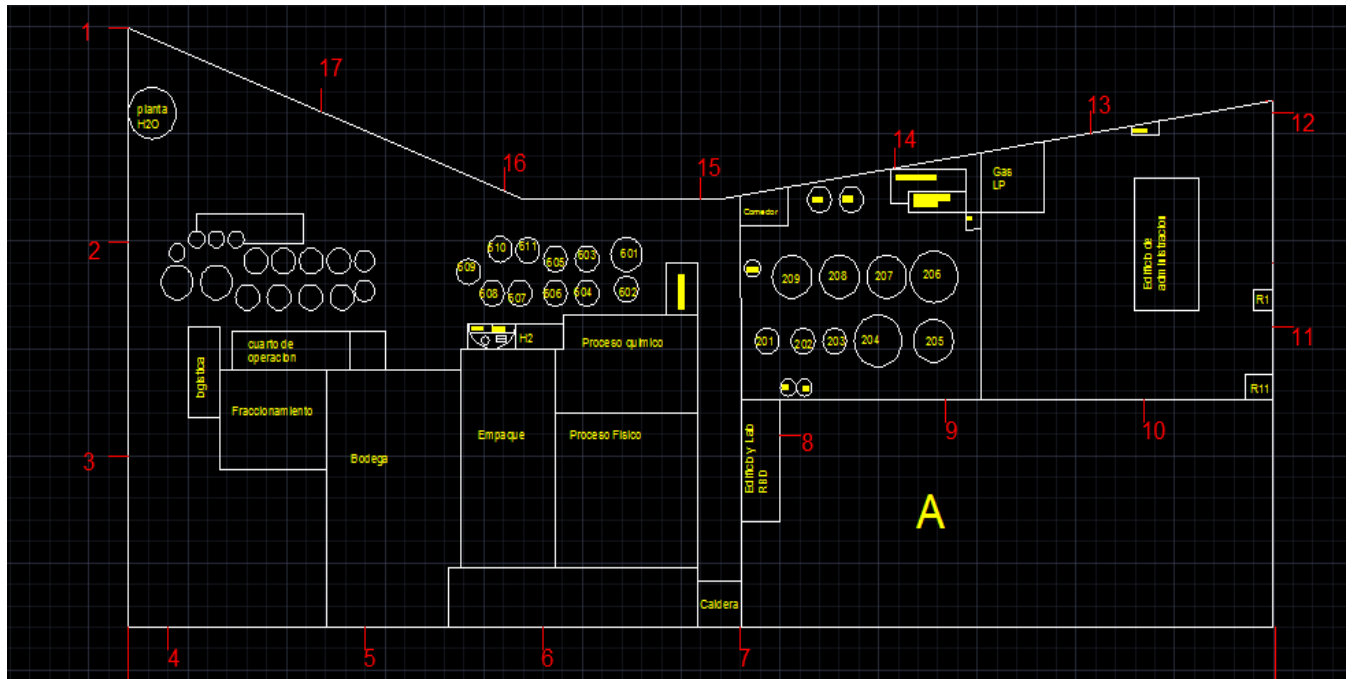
Perímetro de la planta, dividido en segmentos de 50 m.
